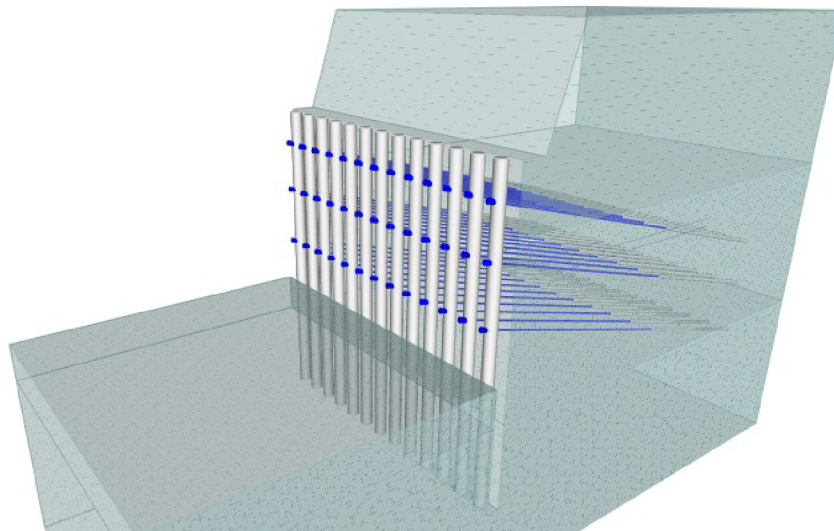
Schéma konstrukce - pilotová stěna s předvýkopem
